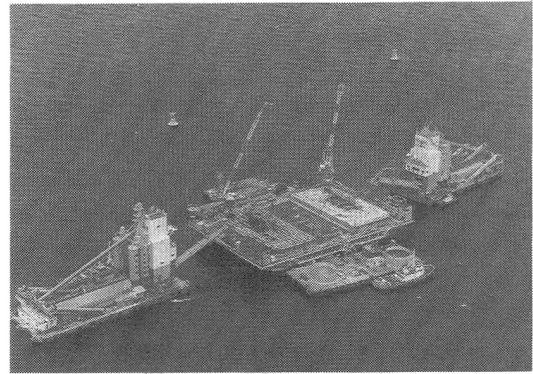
コンクリートプラント船によるコンクリート打設状況 (6P)
